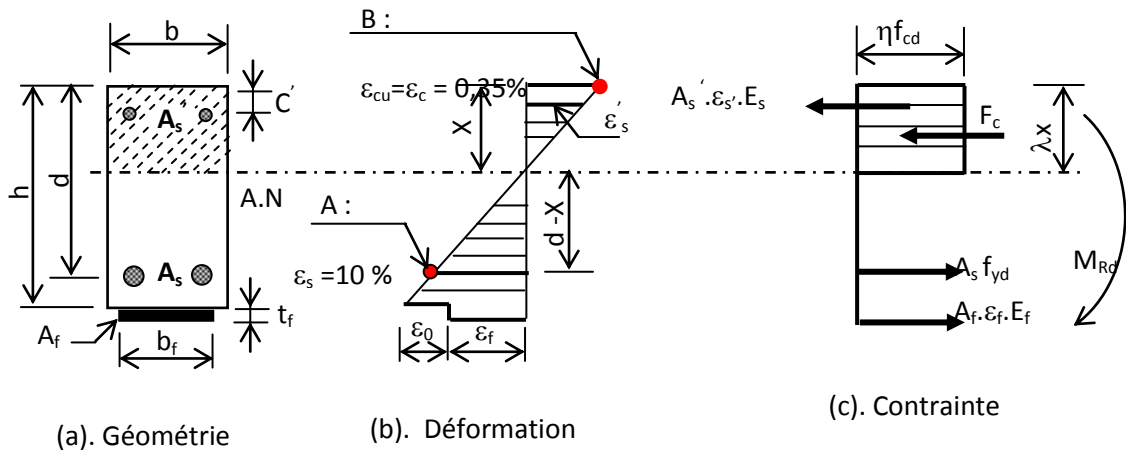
Section transversale d'une poutre en béton armé en flexion simple.
